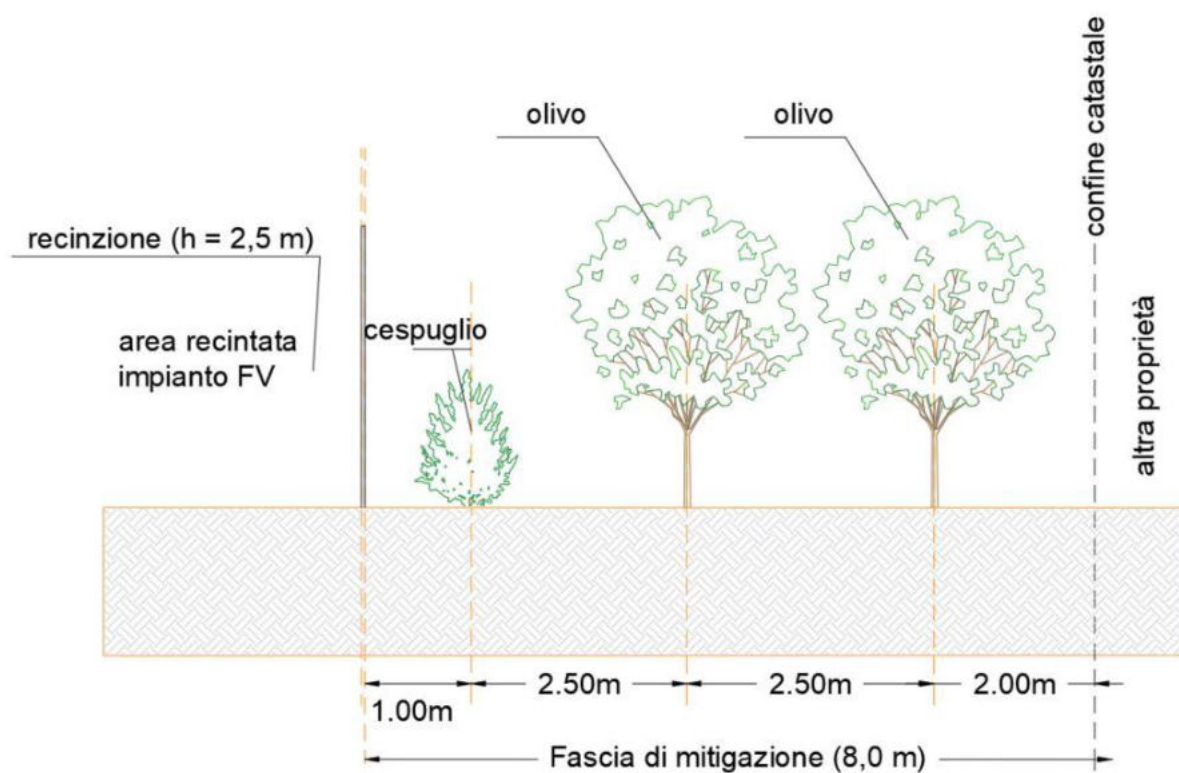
Stralcio di sezione dell'area perimetrale dell'impianto – Siepe e doppio filare di olivo.
